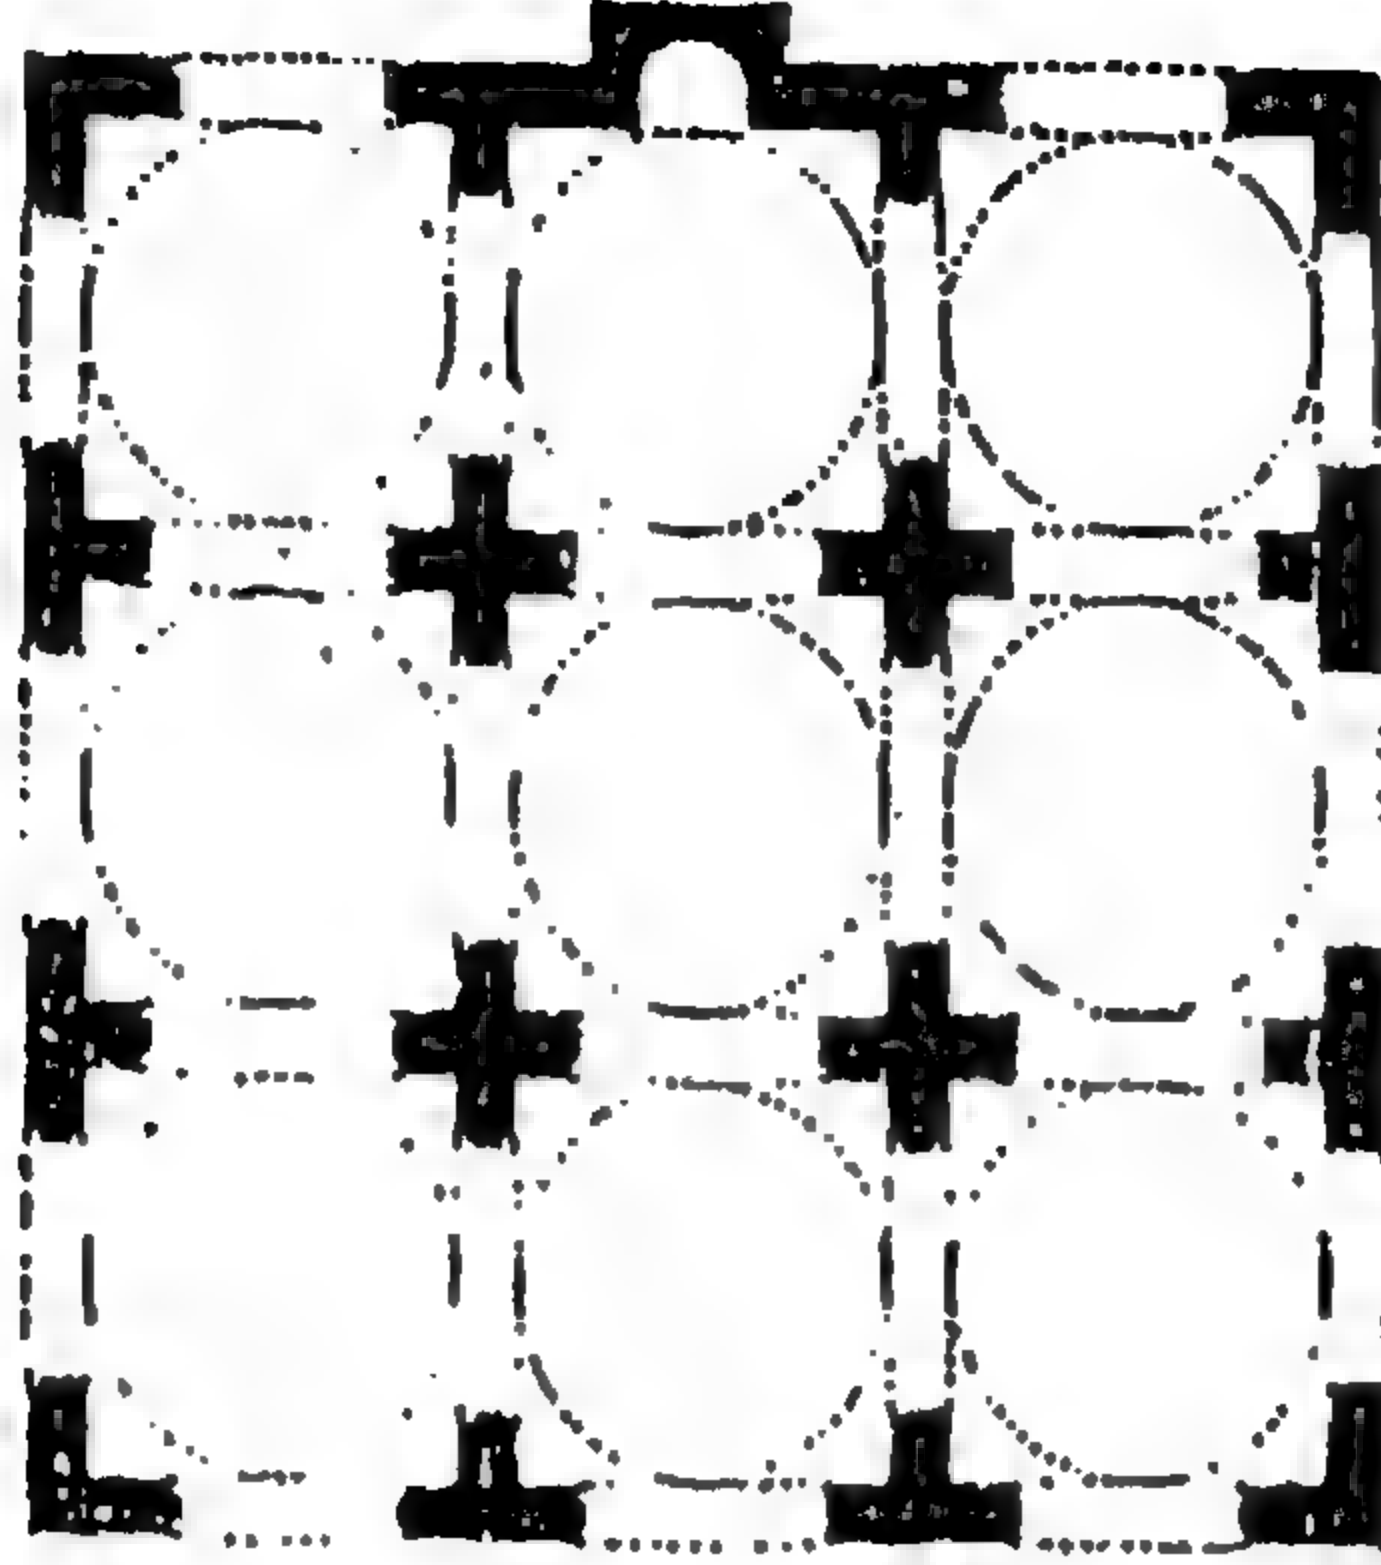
مسقط أفقي لجامع مراد باشا بالقاهرة
